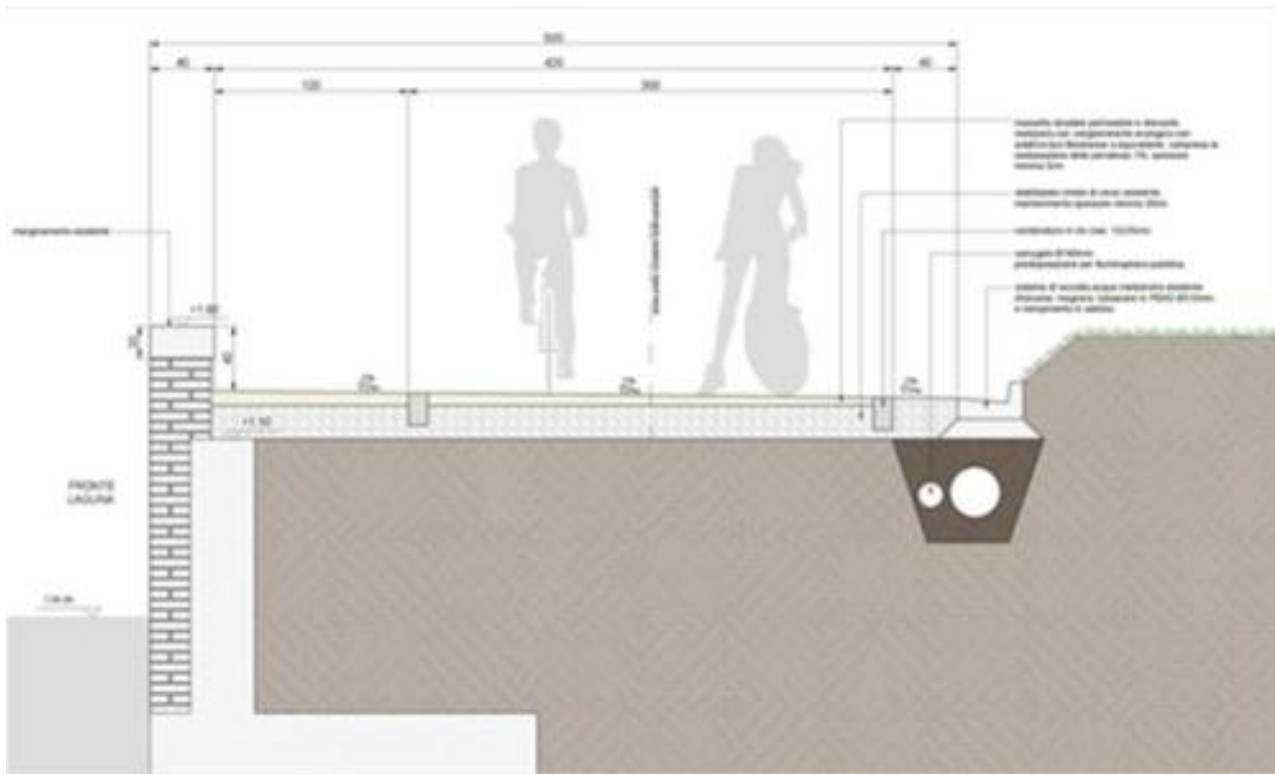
Esempio di sezione tipo della pista ciclopedonale lungo il bordo lagunare.
